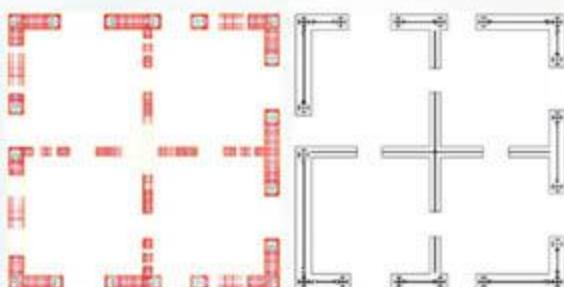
核心筒墙配筋与劲性钢柱、梁典型平面图
